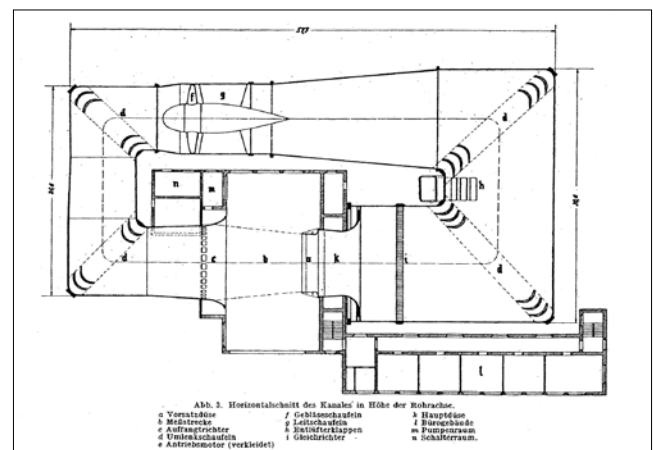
Grundriss des großen Windkanals, 1935
